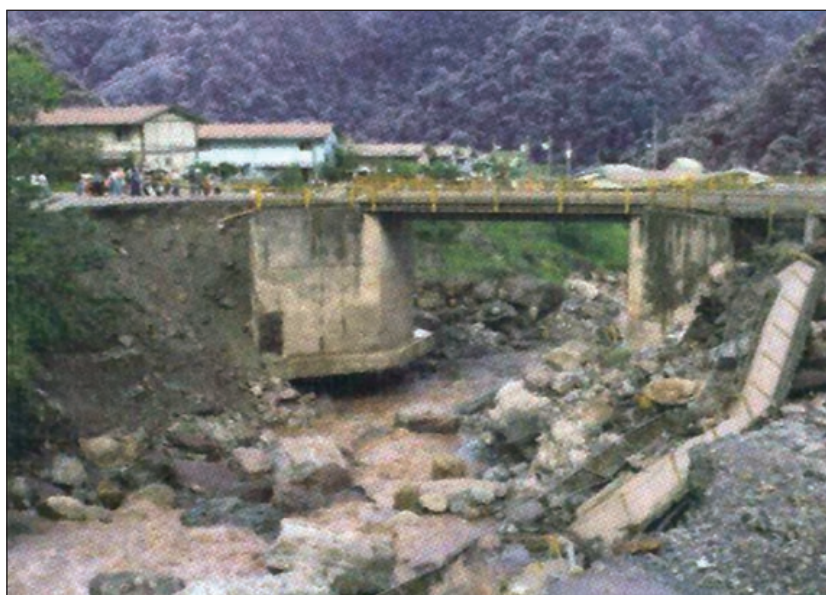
ESTRIBO EN «CAUCE».
